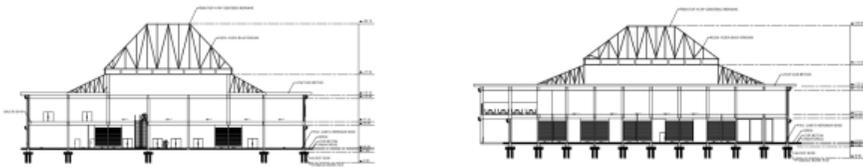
Tampak Depan dan Belakang Bangunan
